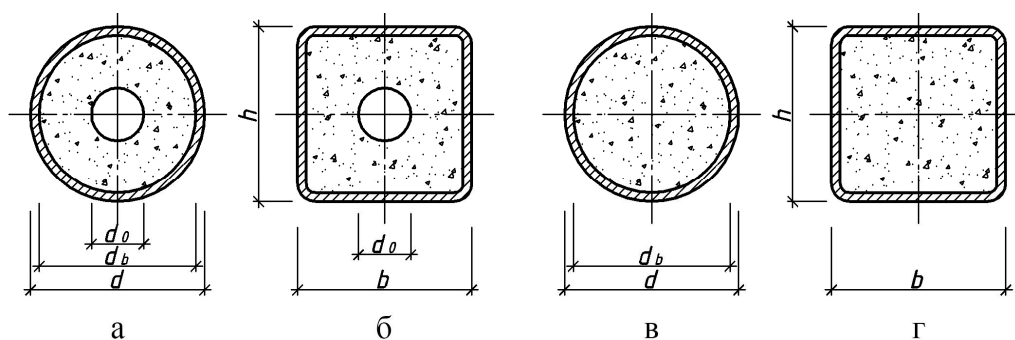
Формы поперечных сечений и варианты армирования бетонного ядра трубобетонных колонн
